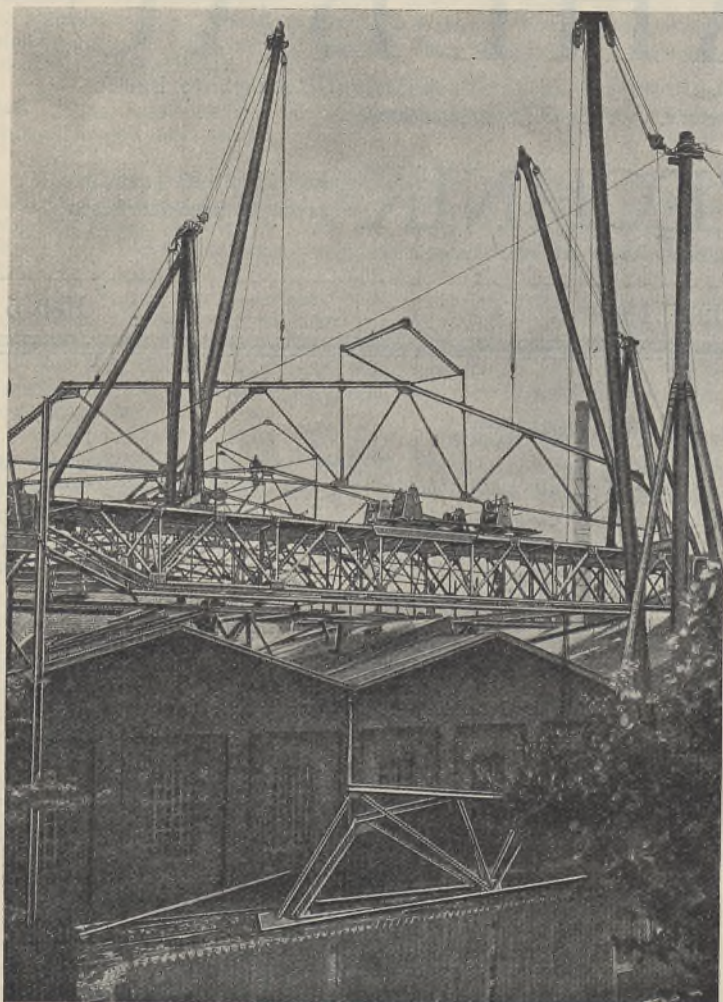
Umbau der Walzwerkshalle R. & G. Schmöhle, Menden i. Westf. (Aufstellungsvorgang).
